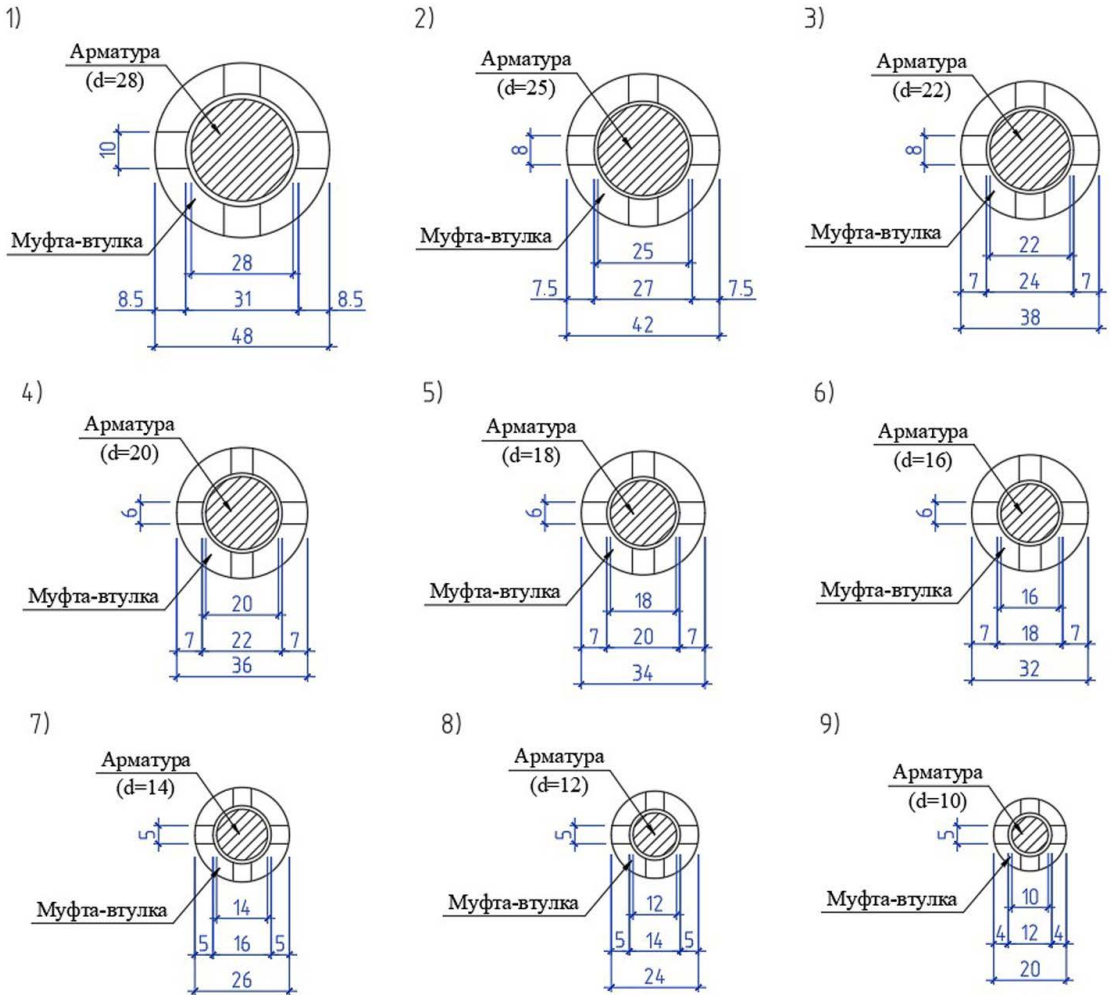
Схемы поперечных сечений сварных соединений арматурных стержней с помощью металлических муфт-втулок с прорезями для сварки (сварка условно не показана)
